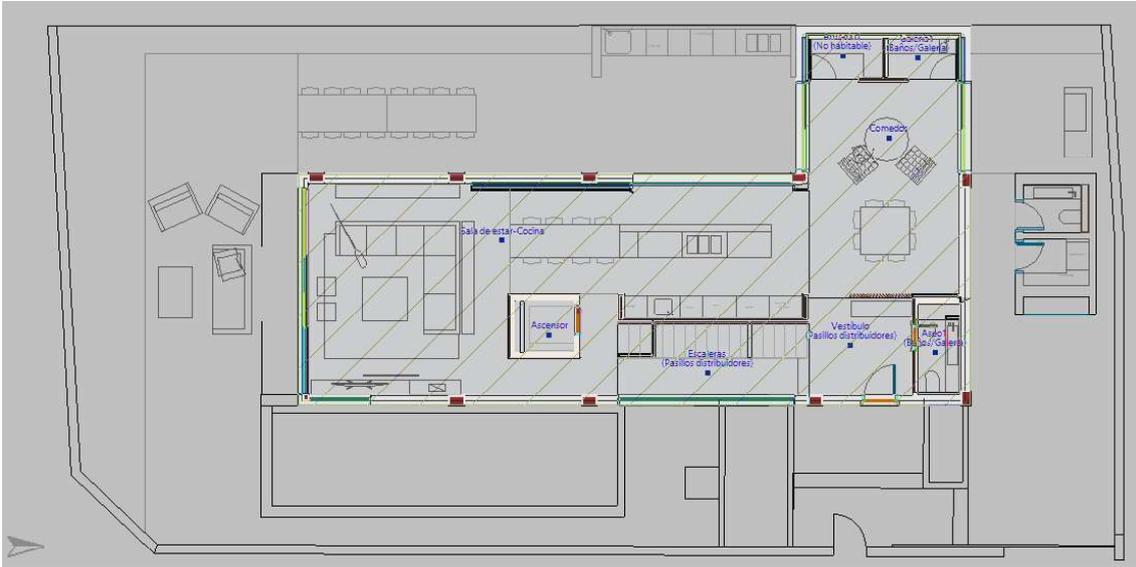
Distribución Planta Baja. Vista: En Planta. IFC Builder
